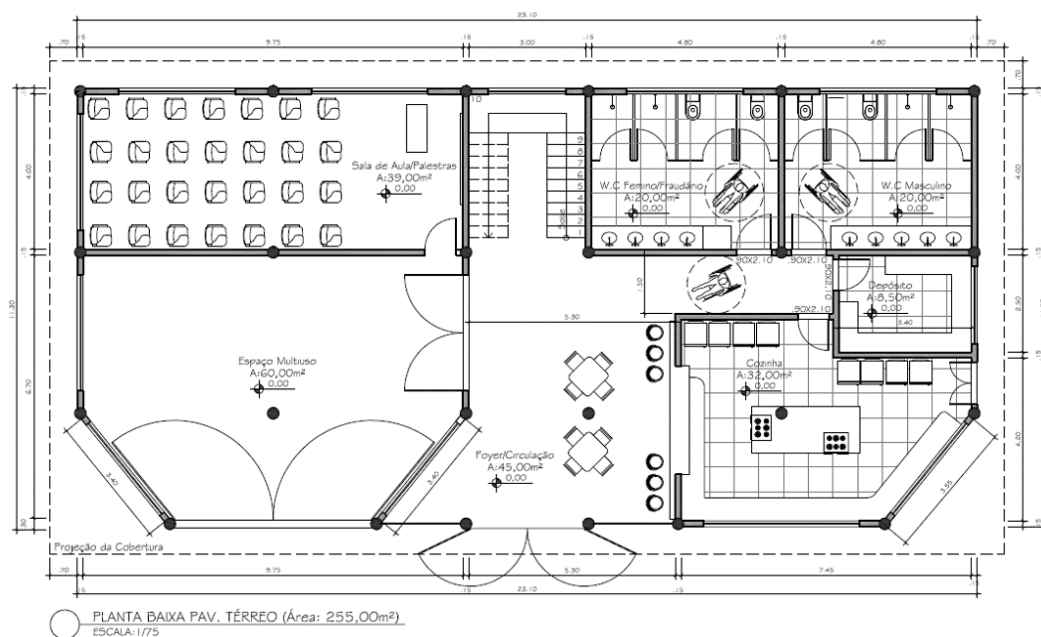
Planta arquitetônica do casarão CED, 1º andar.
